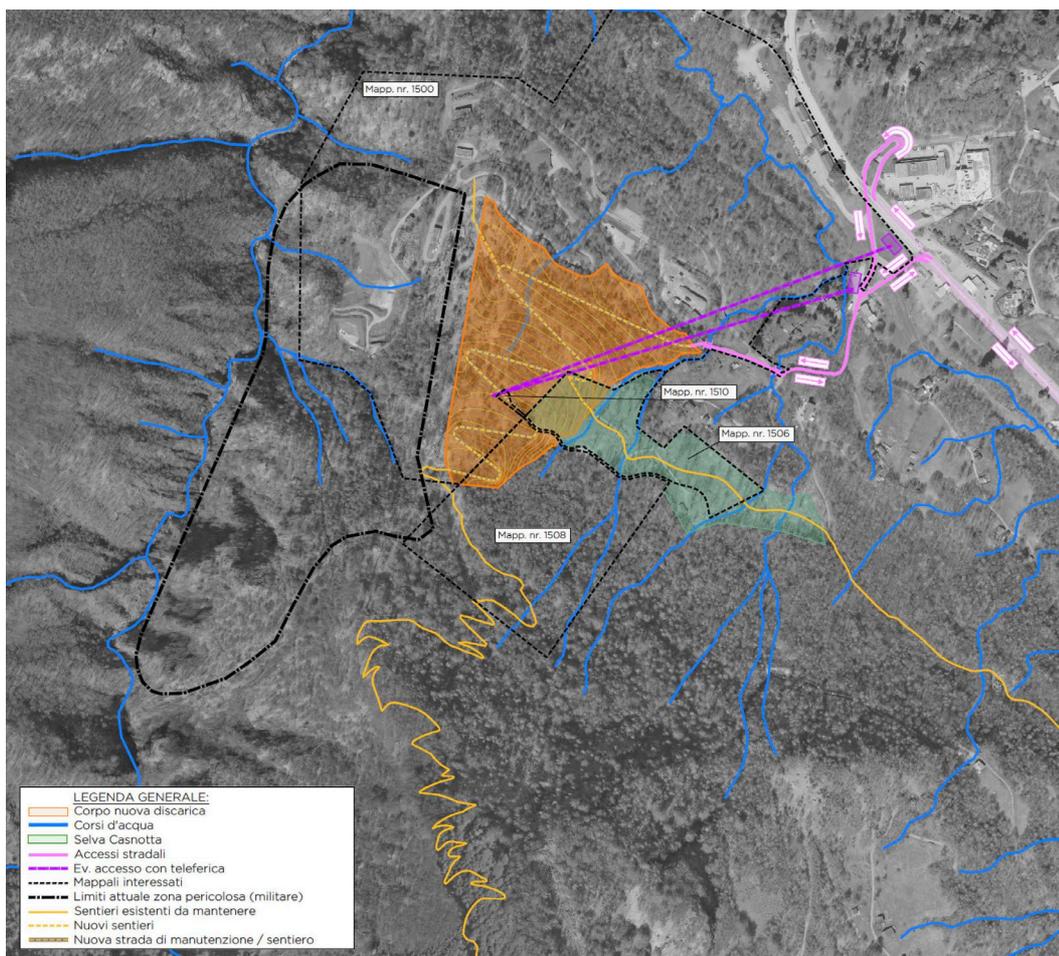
Planimetria discarica Monte Ceneri Ovest<sup>9</sup>
